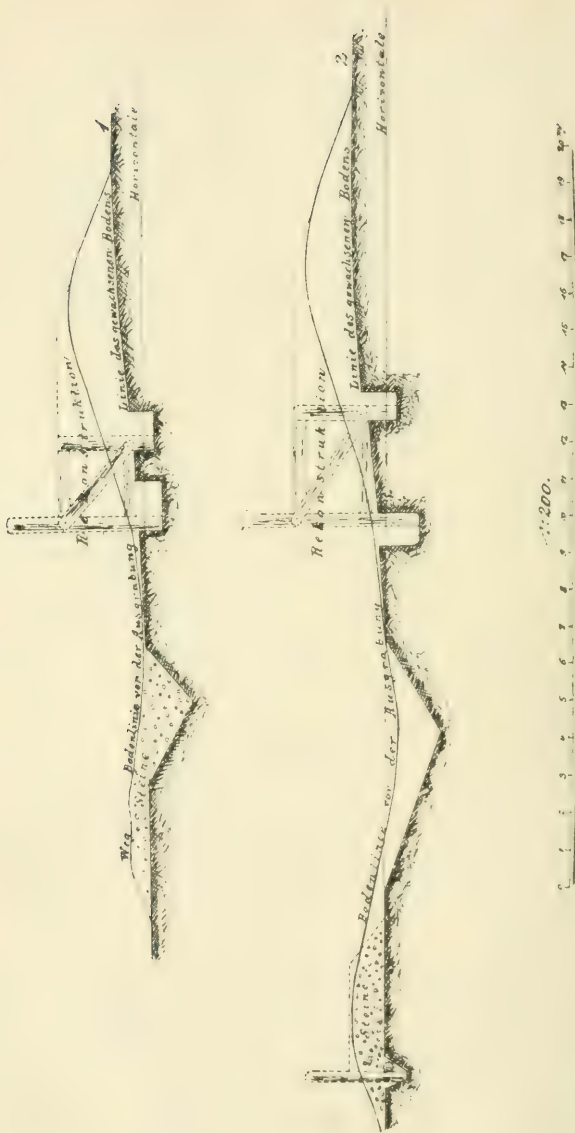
Querschnitt durch Wall und Graben. 1:200.
